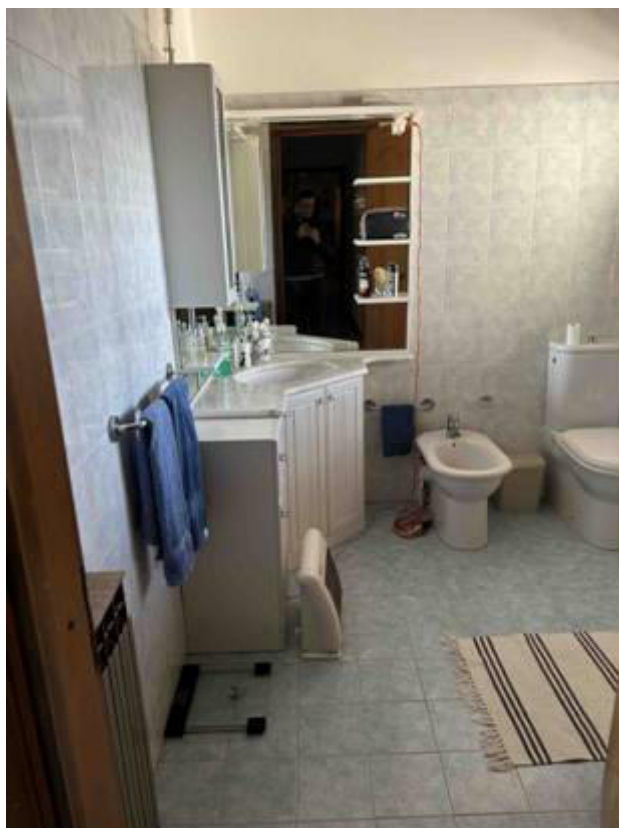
Foto scattata all'interno del bagno principale. La pavimentazione è realizzata con piastrelle in maiolica mentre le pareti sono rivestite con piastrelle in pasta bianca fino all'altezza di 2,40 metri.
